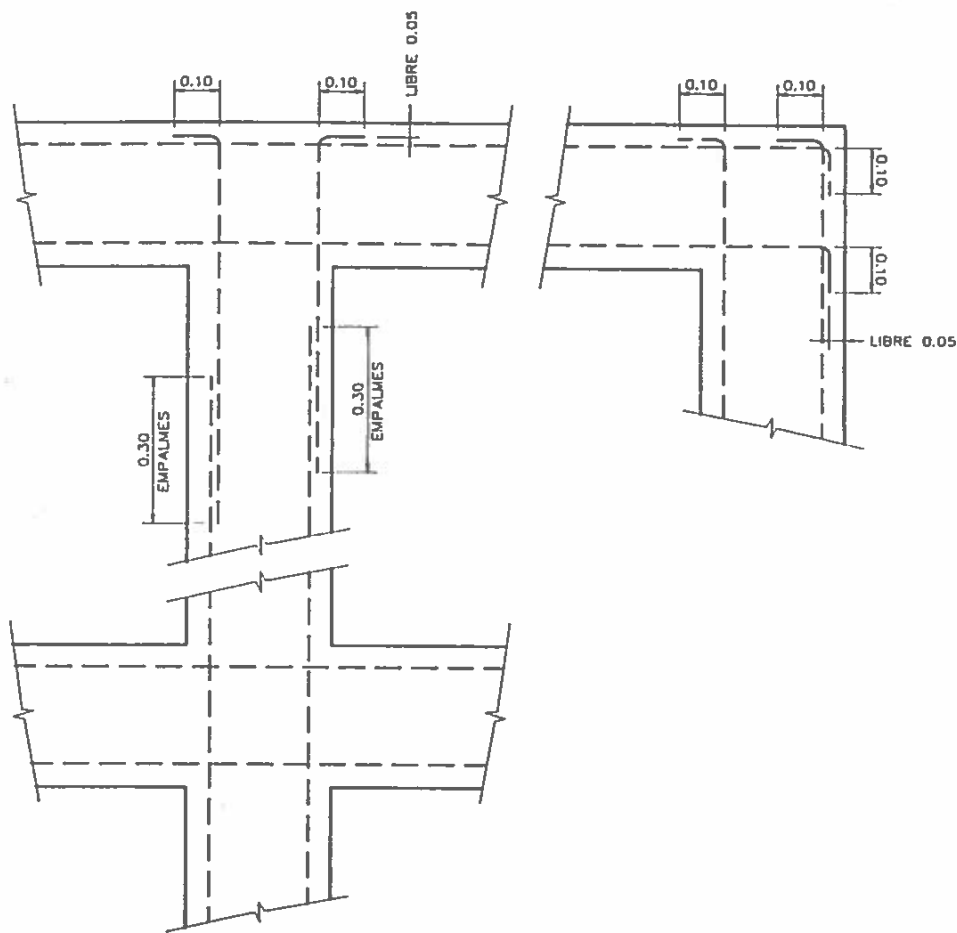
INTERSECCIONES EN PLANTA DE CIMENTOS DE PAREDES
